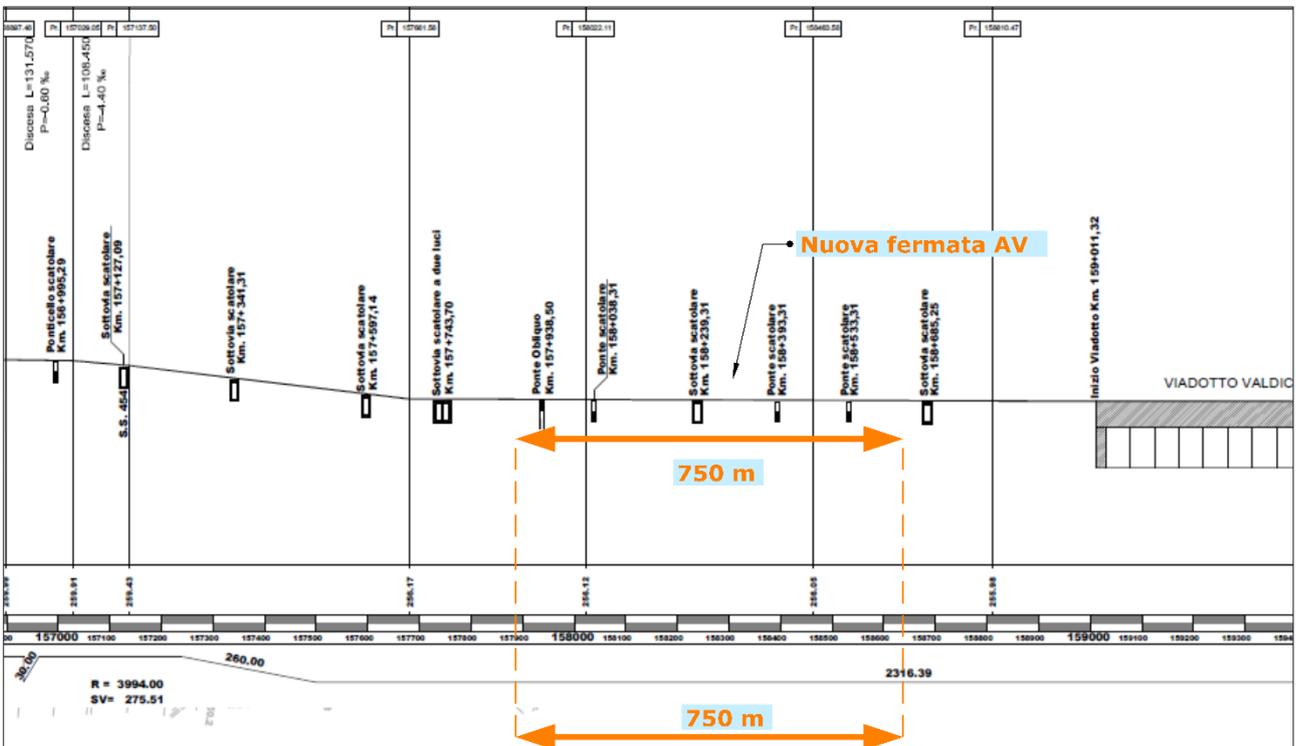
C. Altimetria e andamento della linea nella tratta Salcheto.
